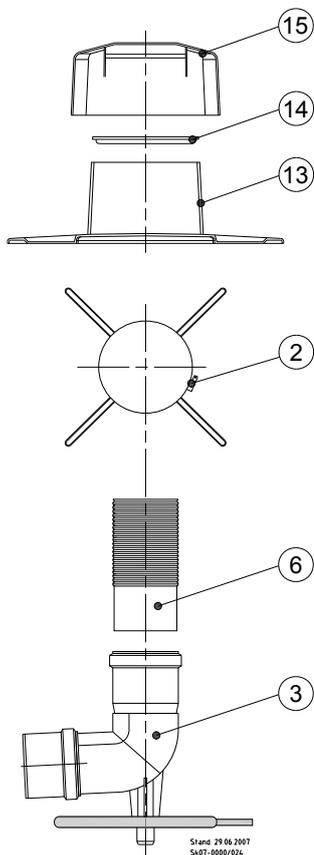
Detail-Zeichnung Befestigung Schachtabdeckung
